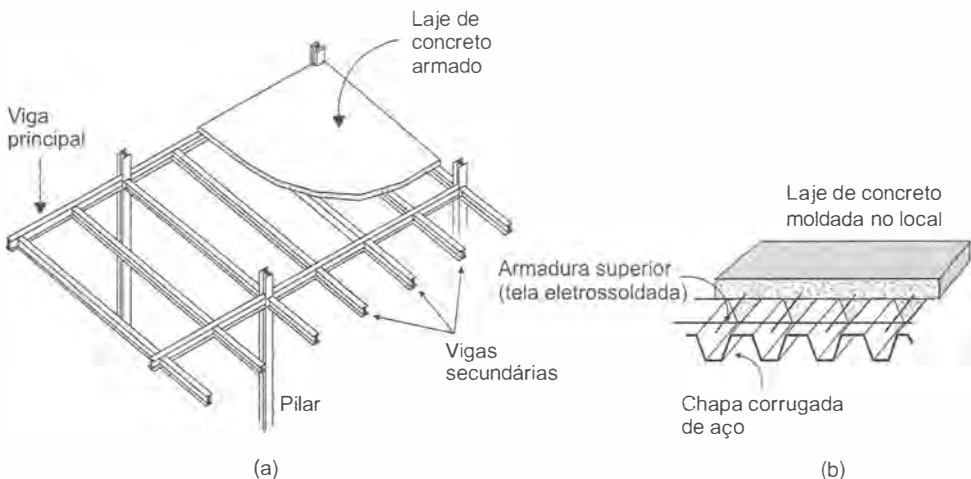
Sistemas de piso em edificações. (a) Vigas principais e vigas secundárias. (b) Laje tipo *steel deck*.
